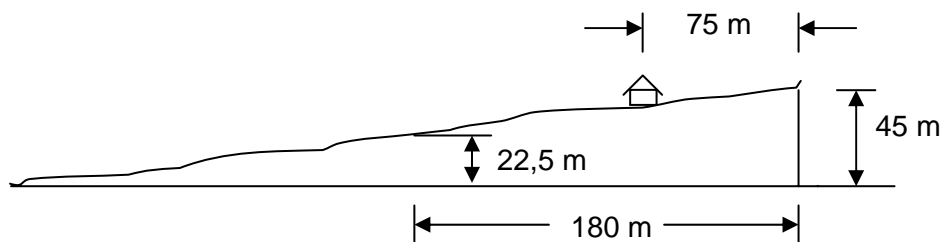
Vivienda de una planta sobre una colina aislada.
